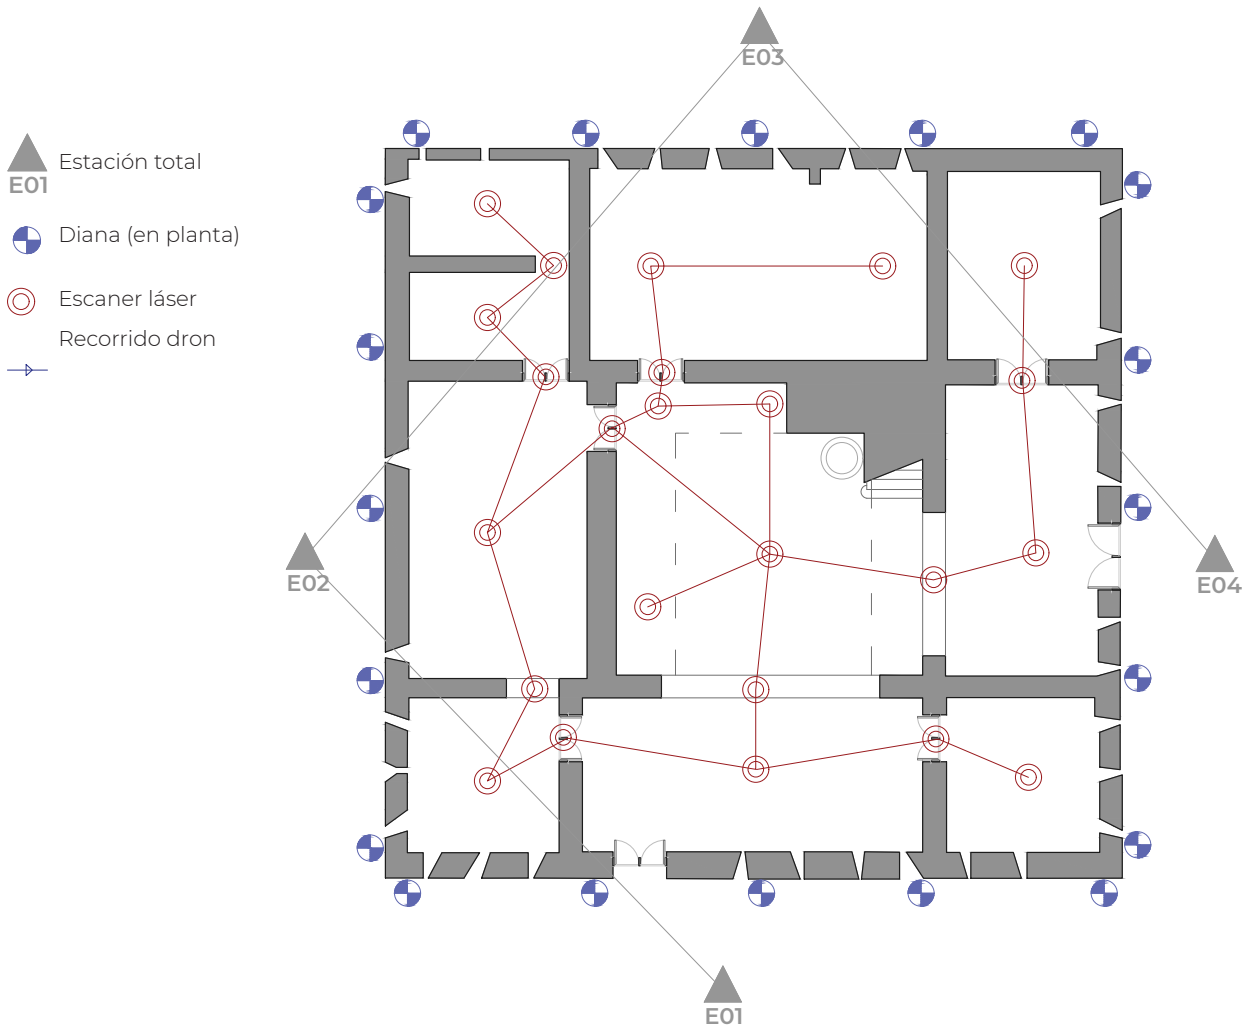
Esquema colocación dianas, estación total y escaner láser. Planta primera
